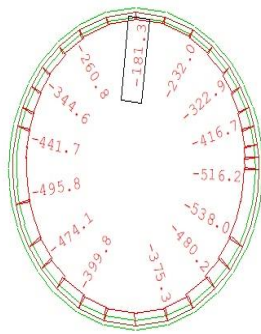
Эпюра моментов, возникающая в конструкции железобетонной обделки на стадии завершения строительства тоннеля в разрезе
